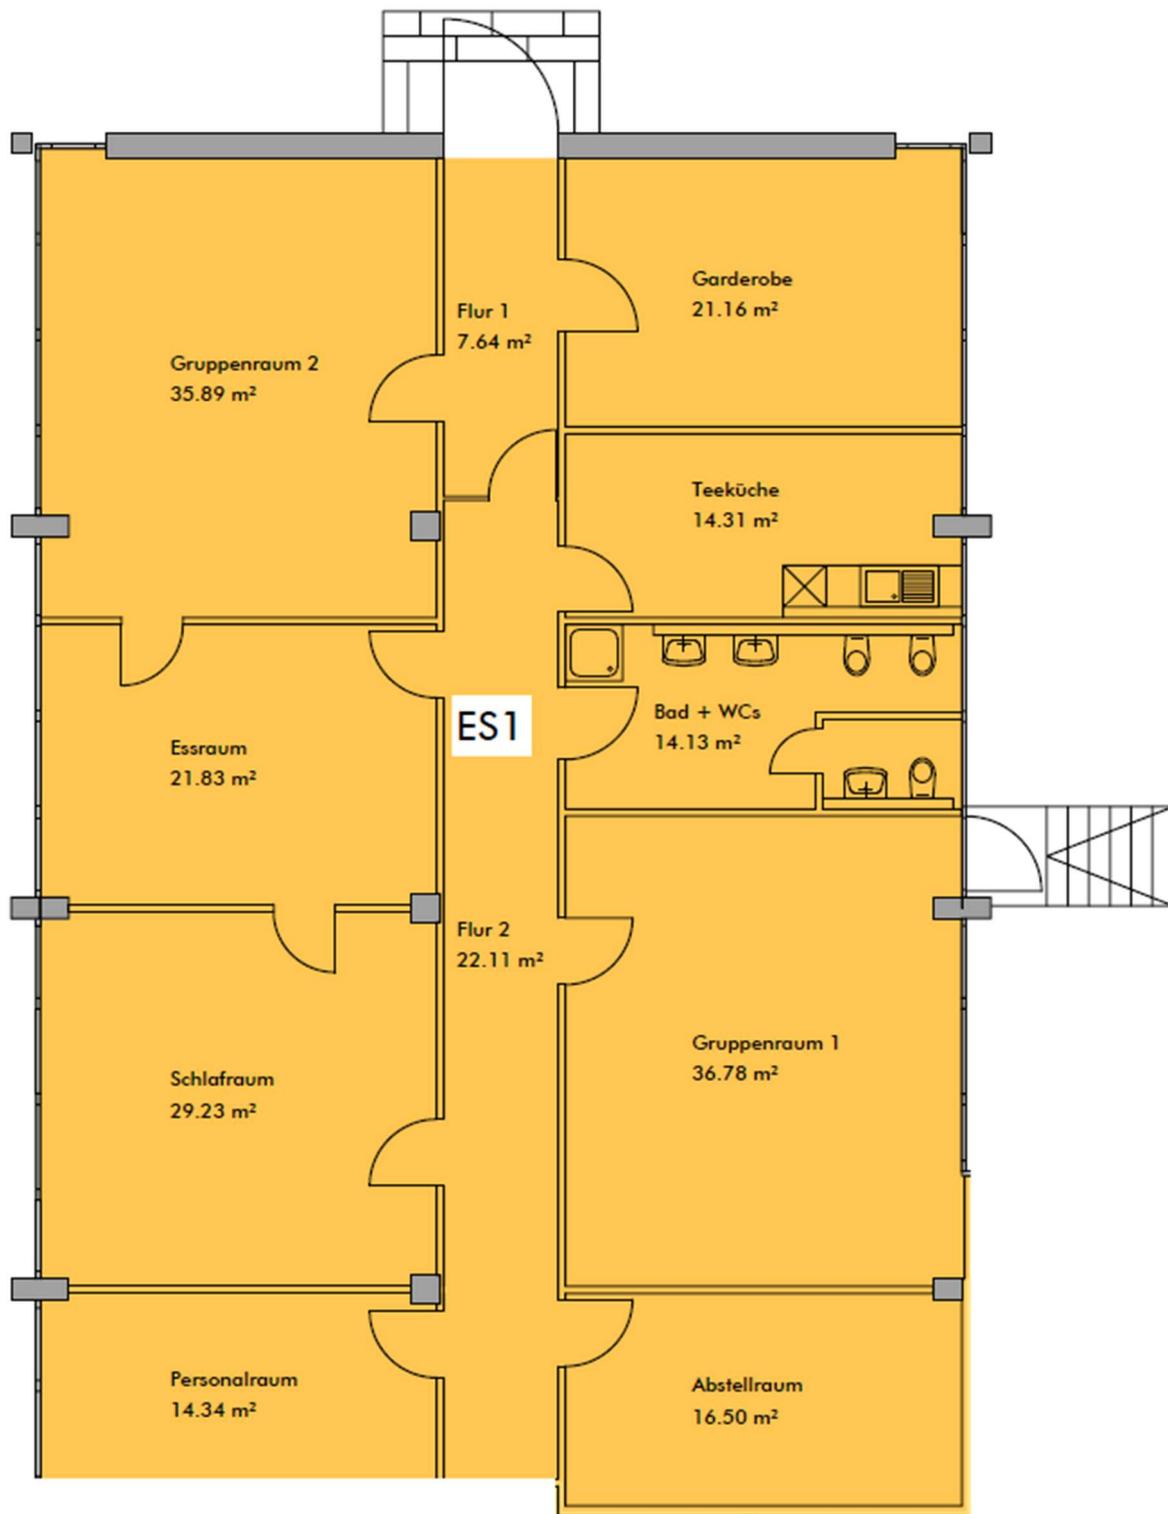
Grundriss Kita Smile e.V.
